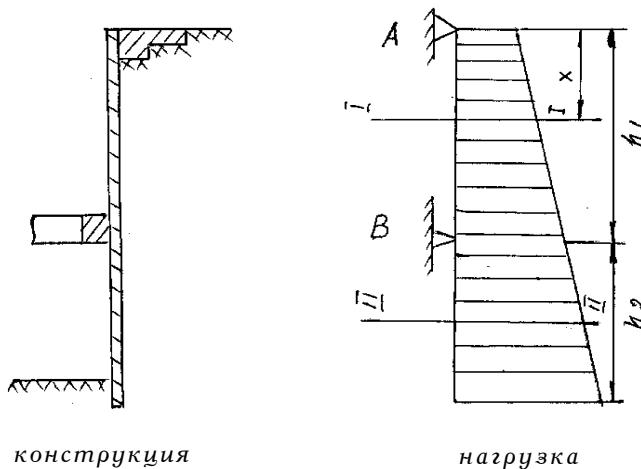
Расчетная схема тонкой заанкеренной неразрезной стены с двумя опорами
